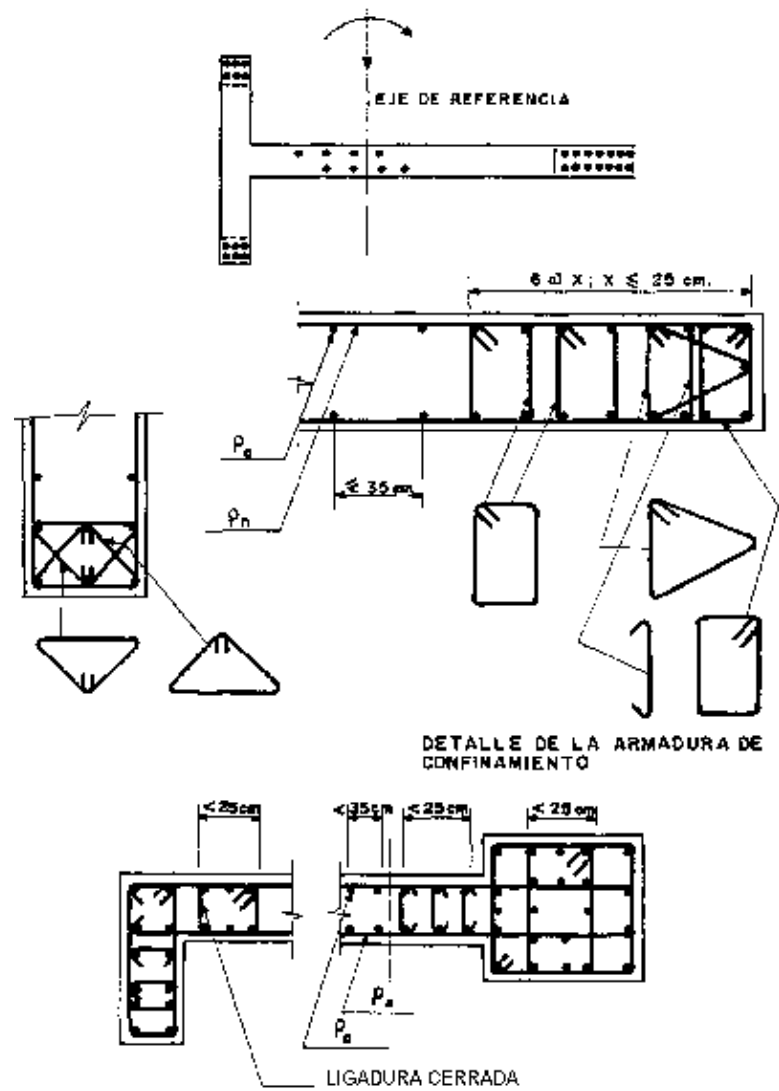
Ejemplos de disposición de armadura en un muro estructural
